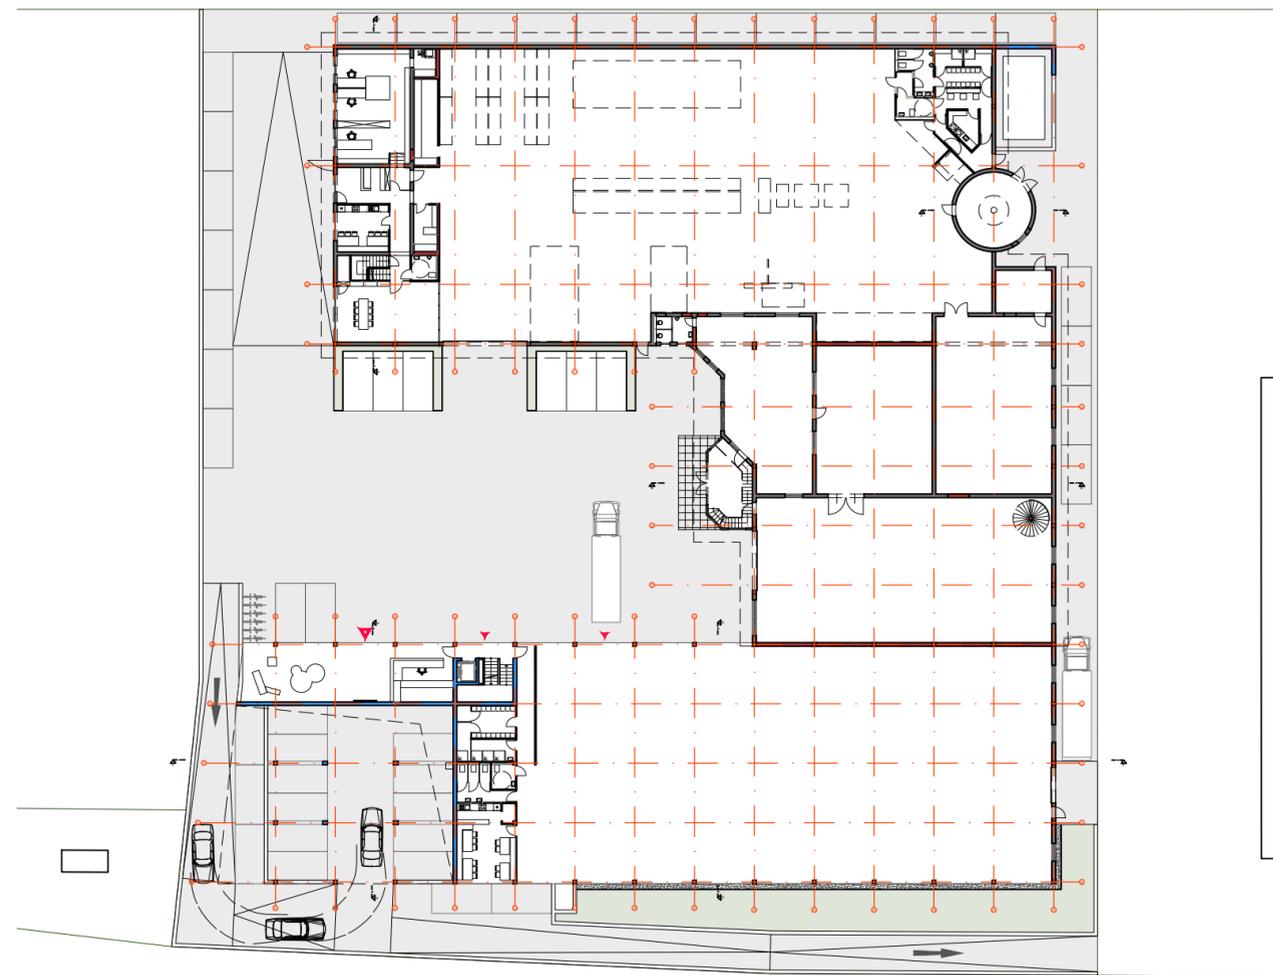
Einrichtung Auswechslung - Grundriss Erdgeschoß
